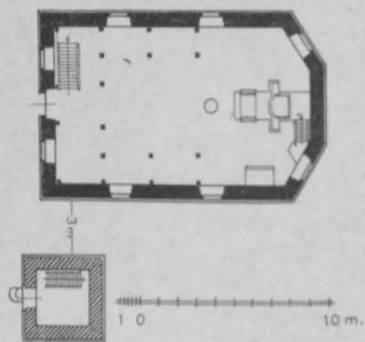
Staupitz. Grundriss der Kirche.
